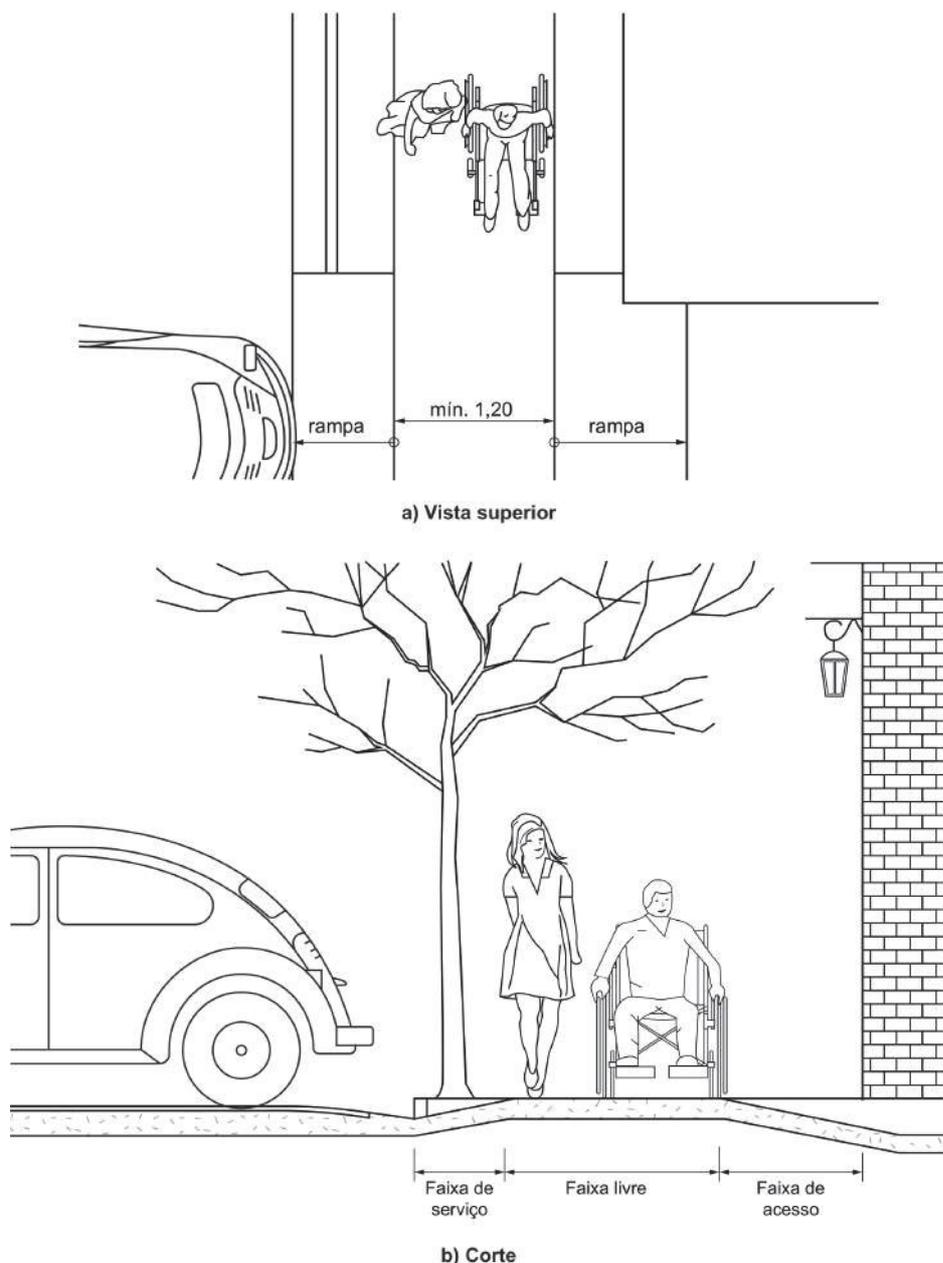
Corte com as faixas de uso da calçada (dimensões em metros)
